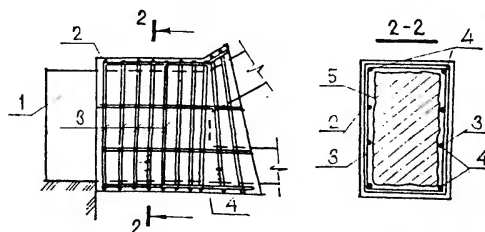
Устройство железобетонной обоймы на опорных узлах
